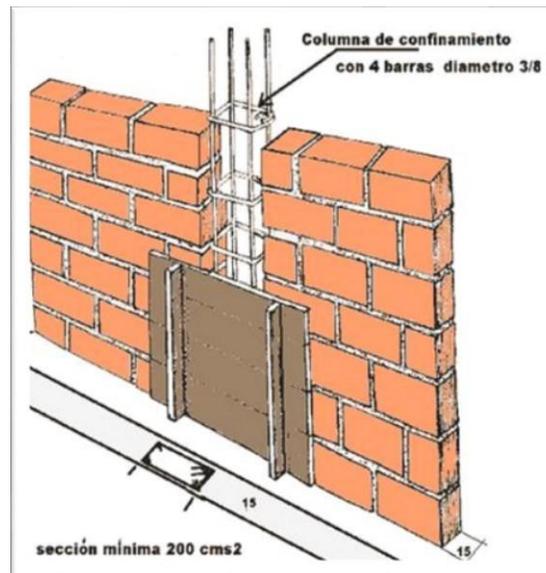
Sistema de Muros Confinados Estructurales (2018).
